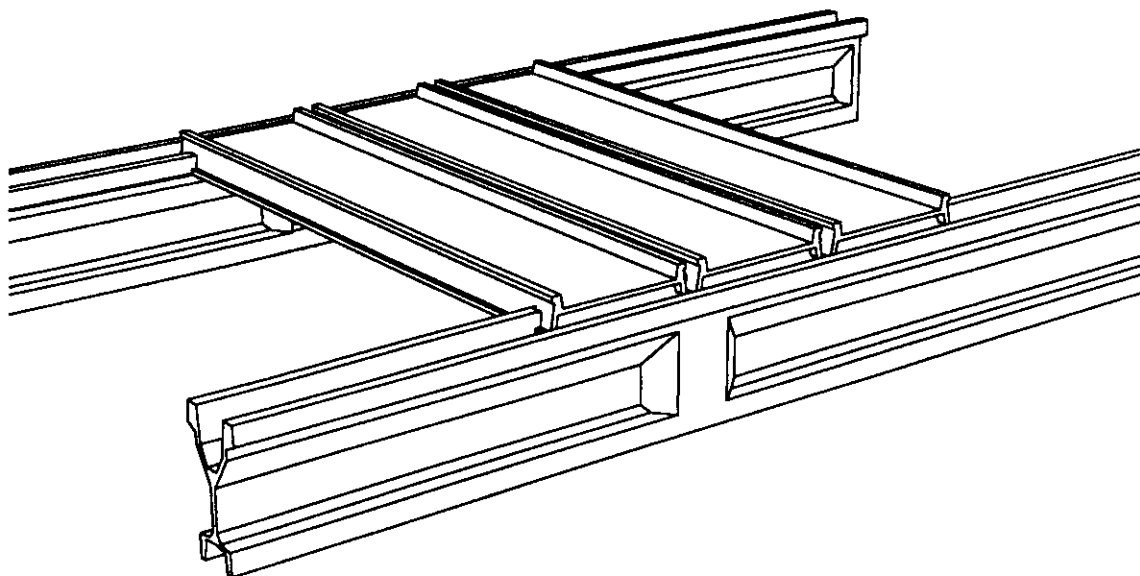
Esquema, em perspectiva, das lajes já posicionadas sobre as vigas de piso.
